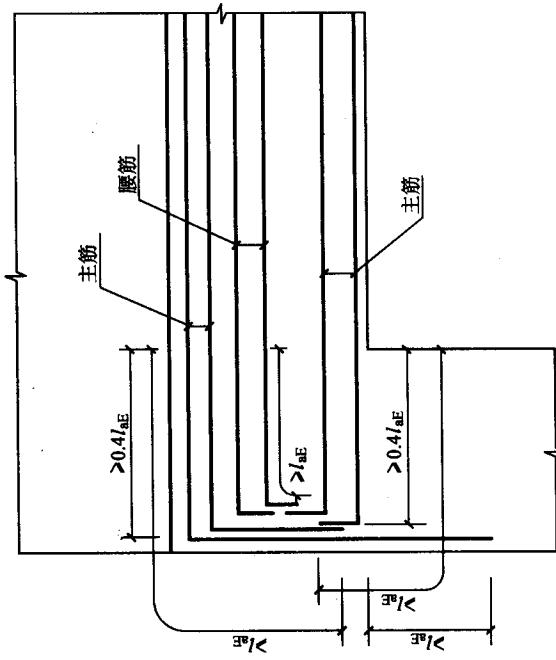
梁上、下纵向钢筋和腰筋的锚固示意图
